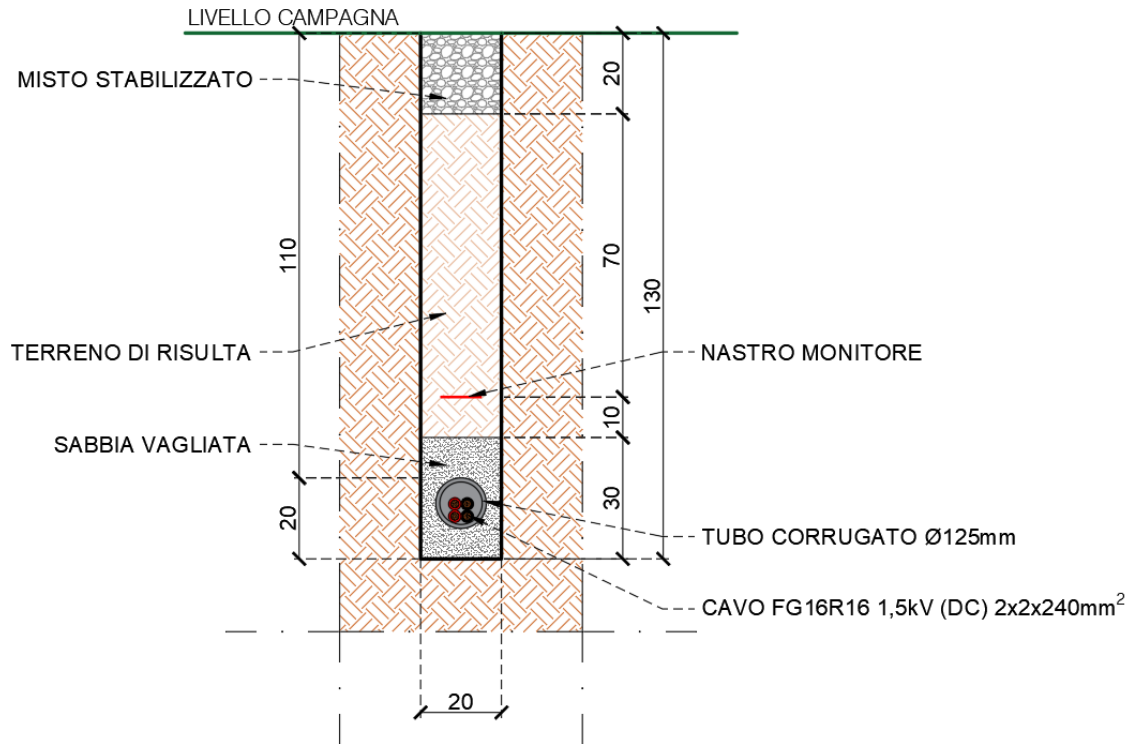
Sezione di scavo cavidotto BT DC (1 linea)
